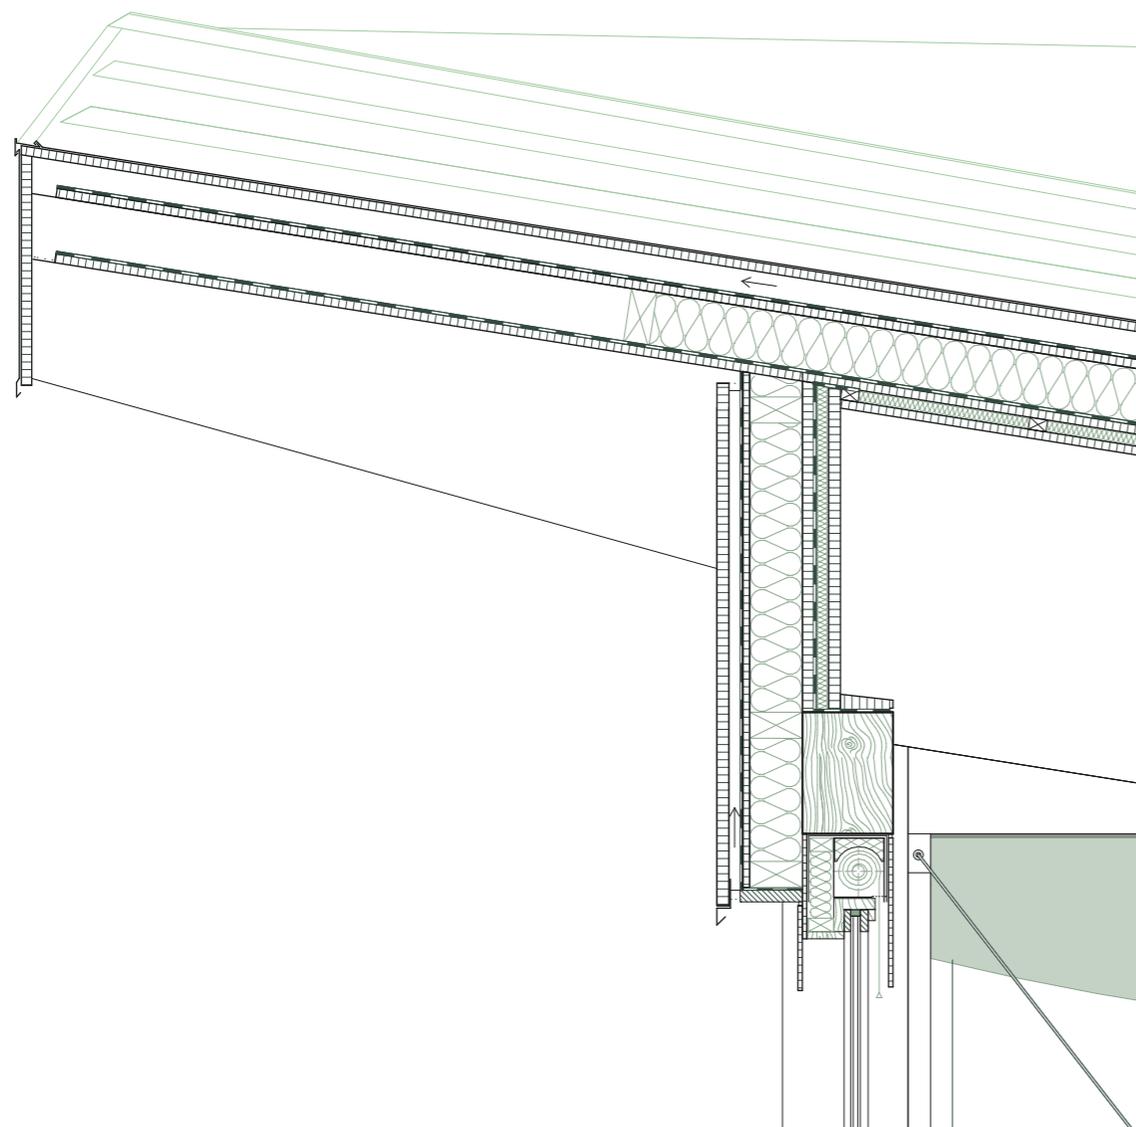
Detailschnitt: Dachaufbau und Außenwand
